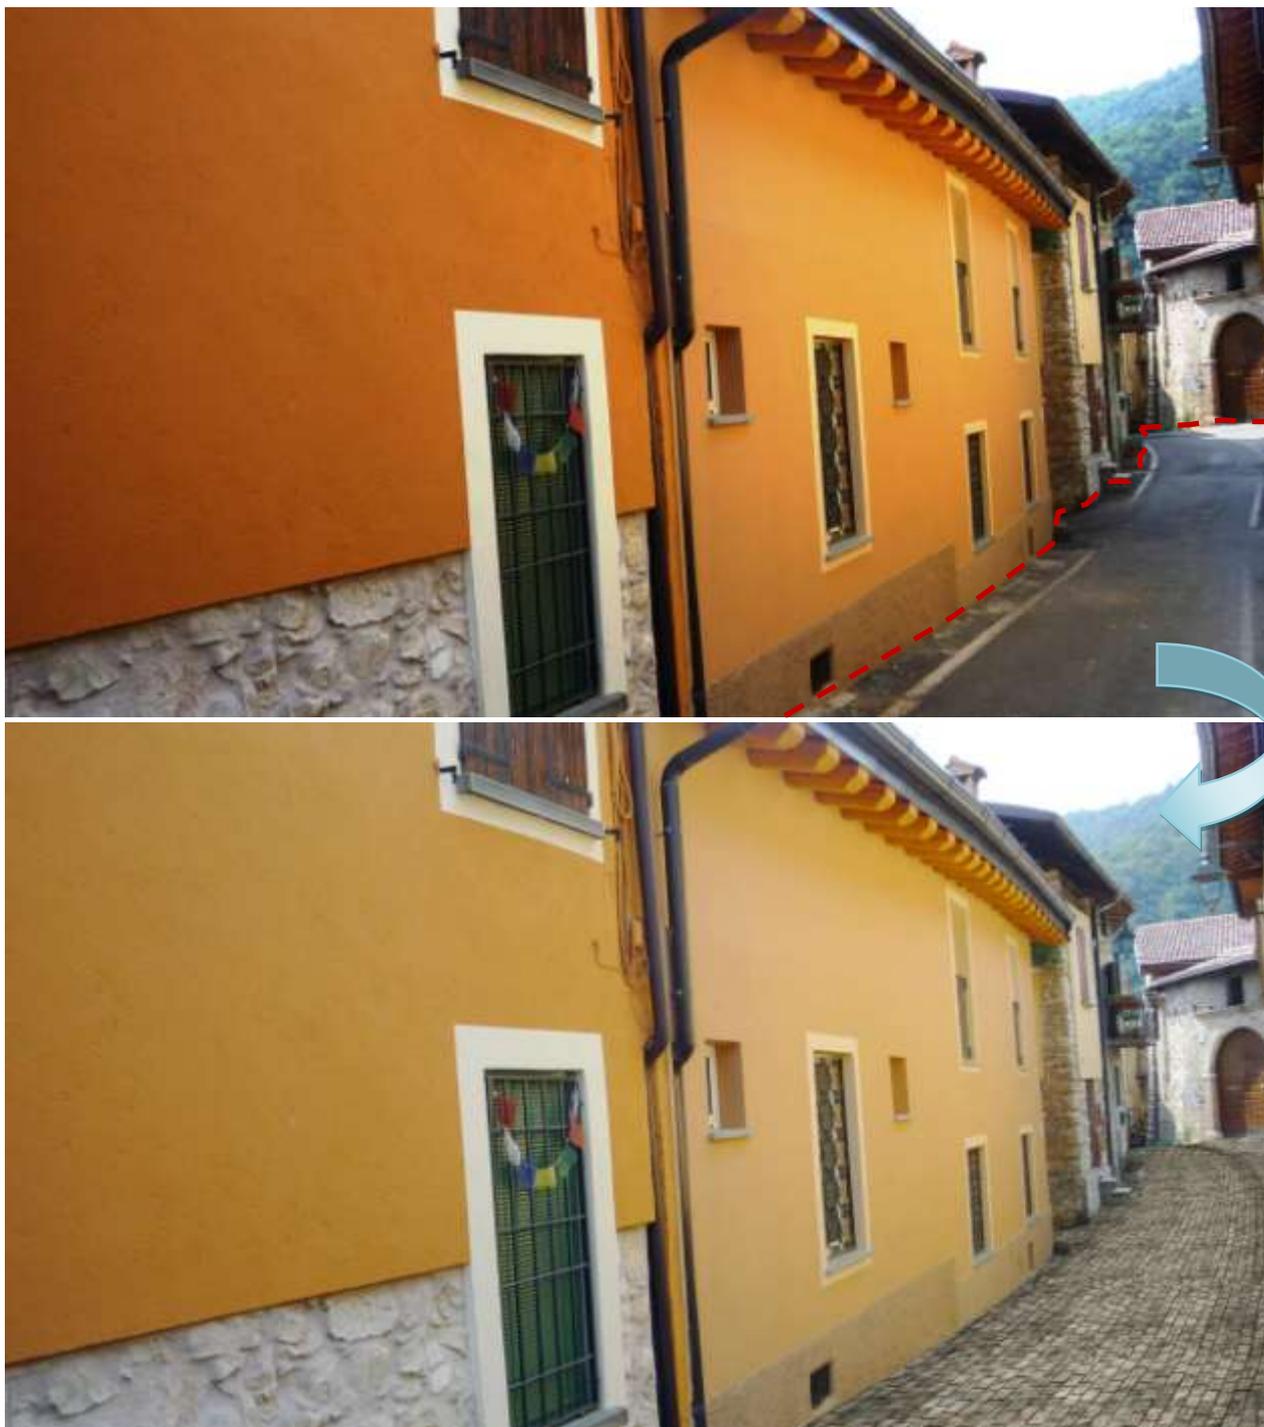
Via Gaina (Stato di fatto-Stato di progetto)
